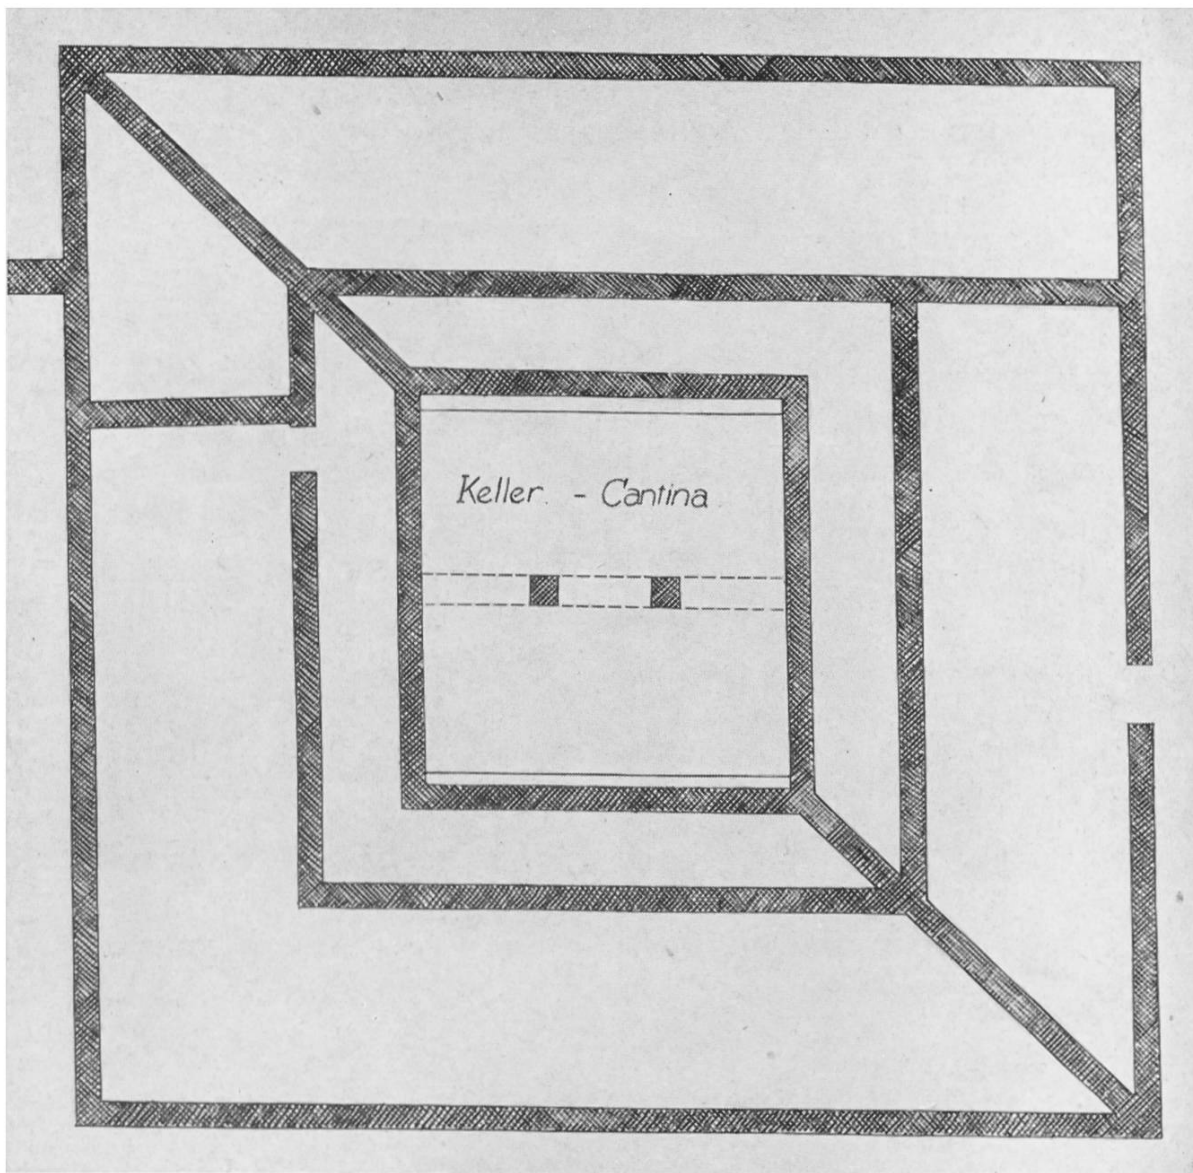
Tegna. Skizze des Grundrisses.
